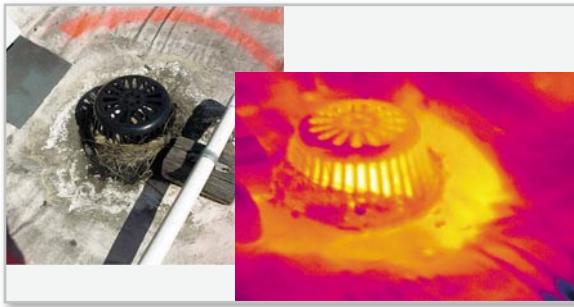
Dachschaden – erst das Thermografiebild entlarvt den konkreten Schaden am Dach. Hier ein Wasserleck im Ablaufbereich eines Flachdachs. (Bilder: FLIR)
